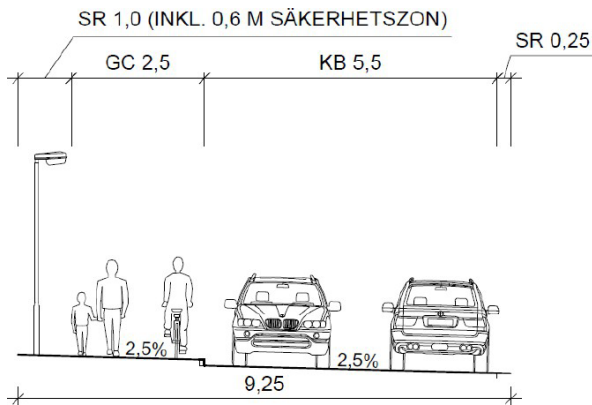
Typsektion för vägen som kopplar till Höviksnäsvägen.
